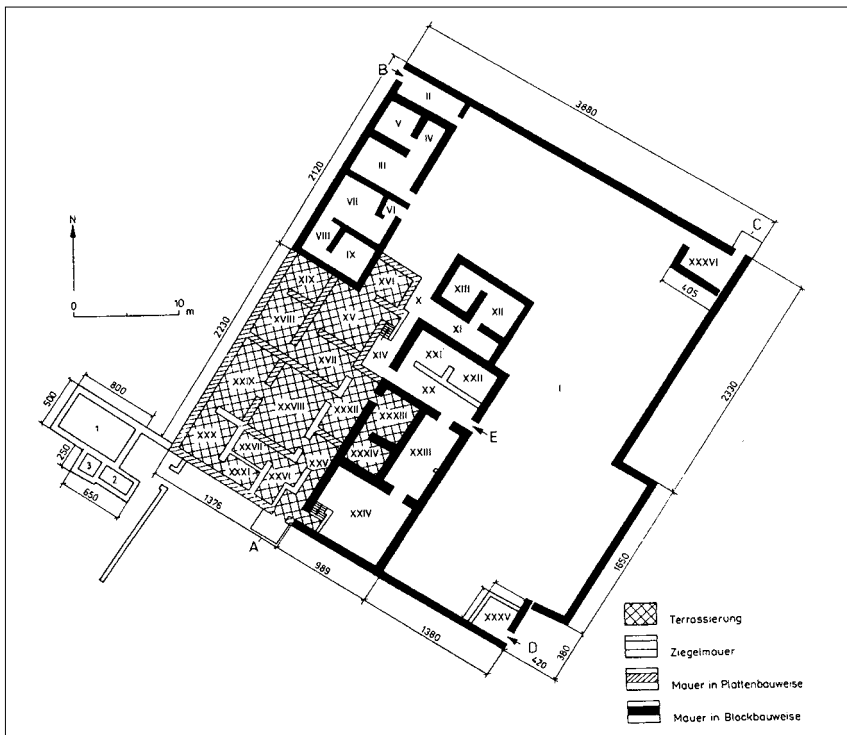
Grundriss der Kleinen Anlage mit Raumnummern.
